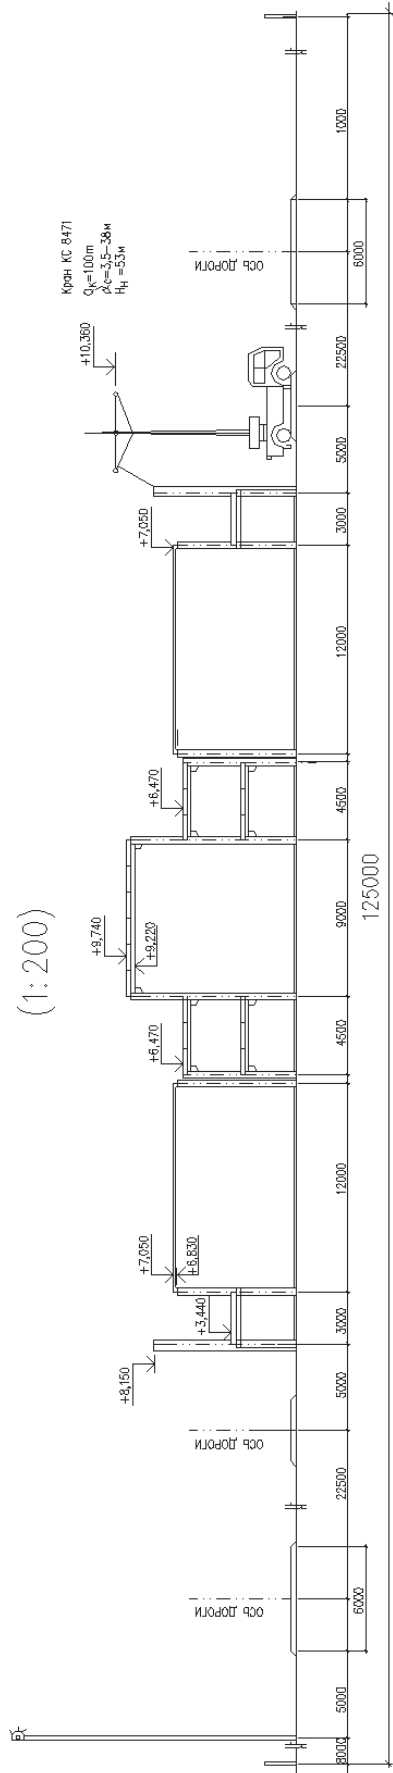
Разрез 1-1 строительного плана (см. рисунок 21)
